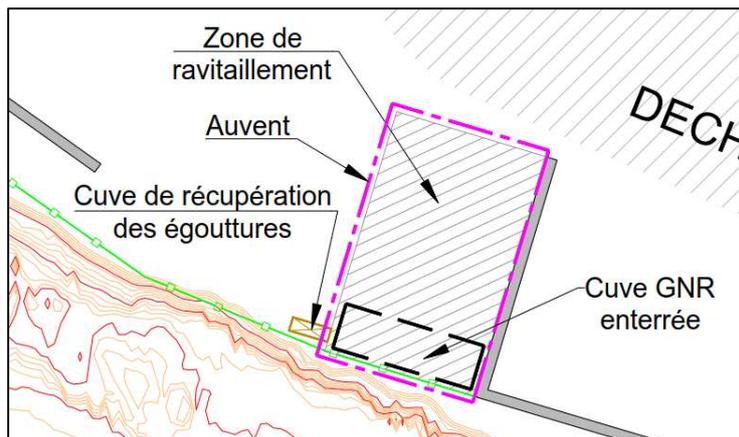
EXTRAIT DU PLAN DE MASSE SUR LA ZONE DE RAVITAILLEMENT DES ENGIN
